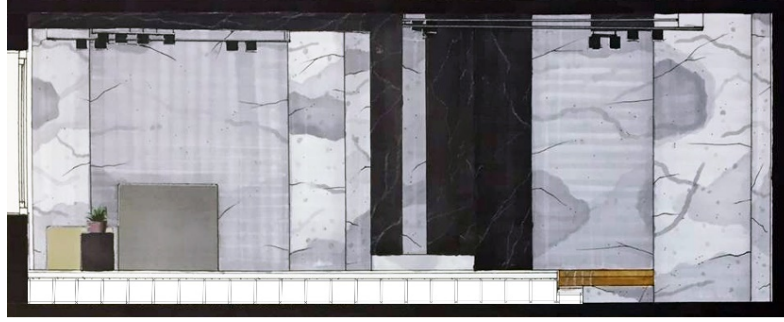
Proje 1 Öğrencinin 1/20 Plan Çizimi
